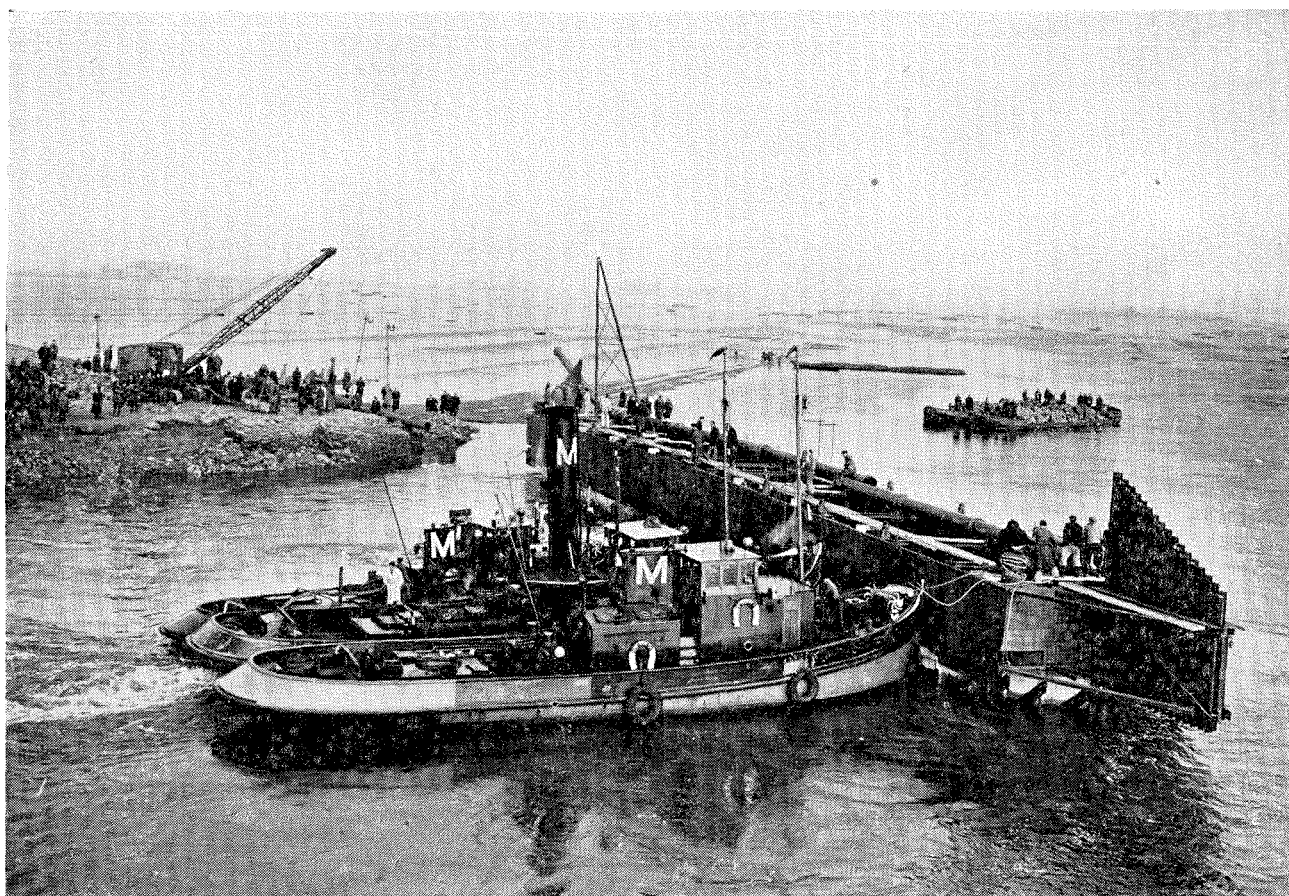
Polder Oudenhorn. Dijkbres bij Hellevoetsluis. Afsluitelement bestaande uit 2 betonnen schepen met stalen opbouw. De aan beide zijden opgehangen damwandschermen worden na plaatsing van de caisson op de aansluitende steentaluds neergelaten.
